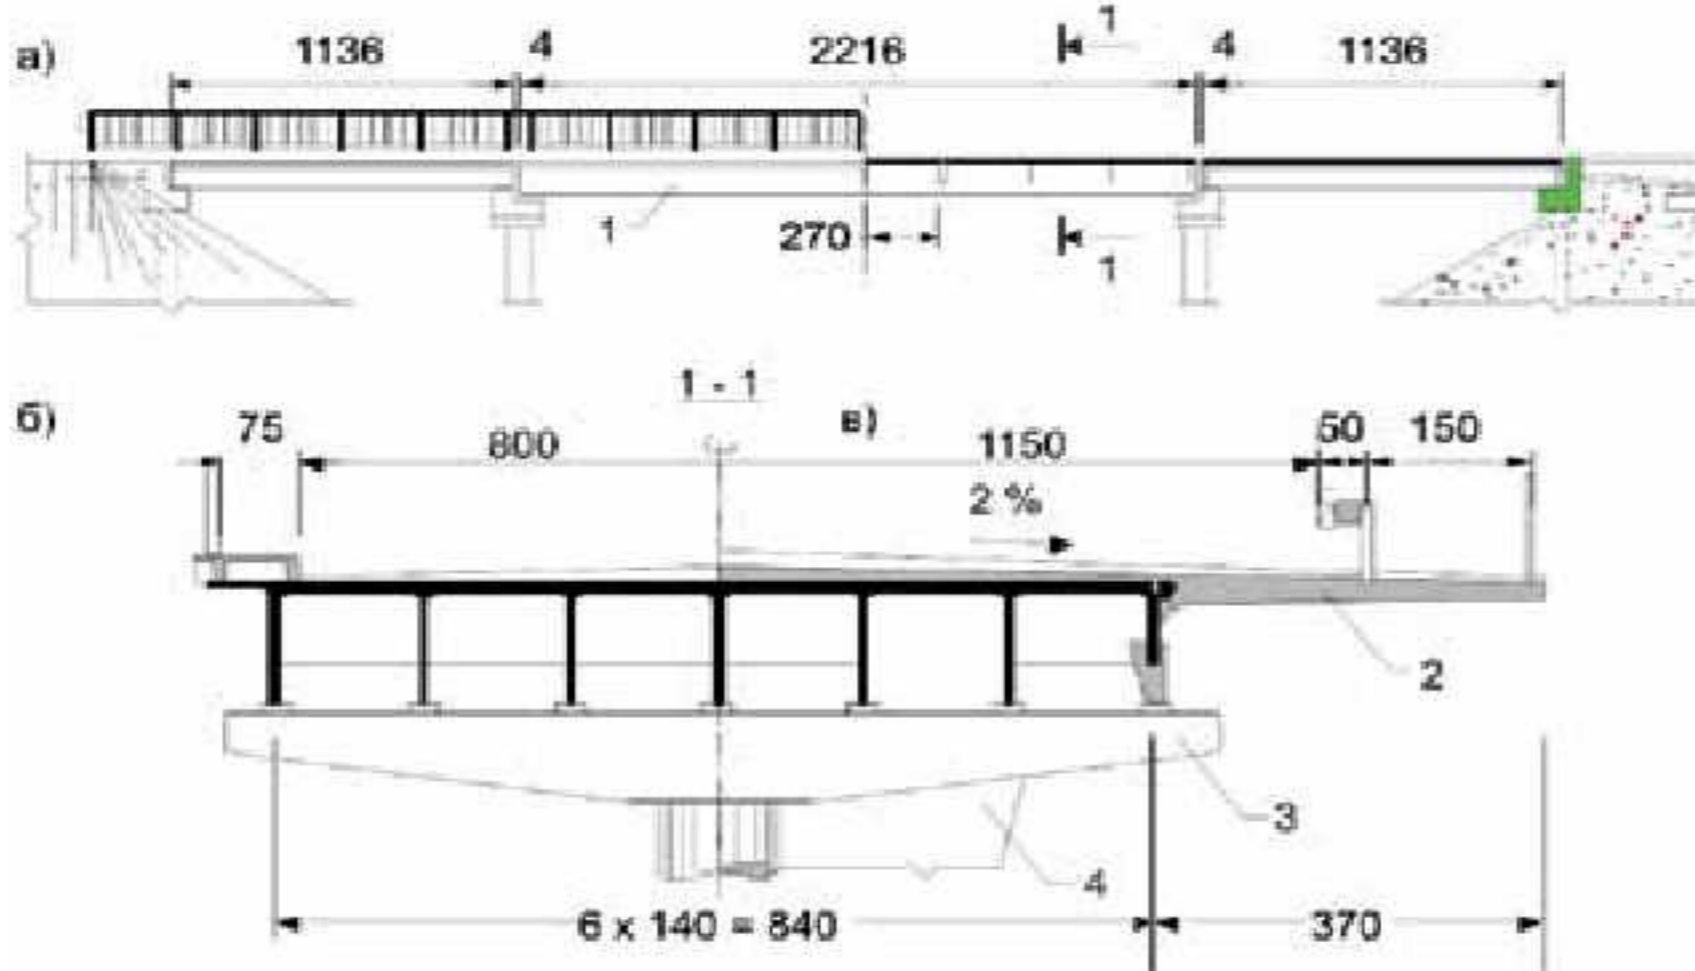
Конструкція існуючої (а, б) і розширеної (в) прольотної будови: 1 - існуюча прольотна будова; 2 - монолітна залізобетонна накладна плита; 3 - ригель проміжної опори; 4 - залізобетонна конусоподібна стінка підсилення проміжної опори
